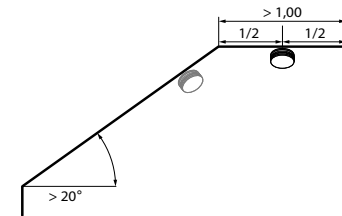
Gerade Montagefläche mindestens 1 m lang und 1 m breit
